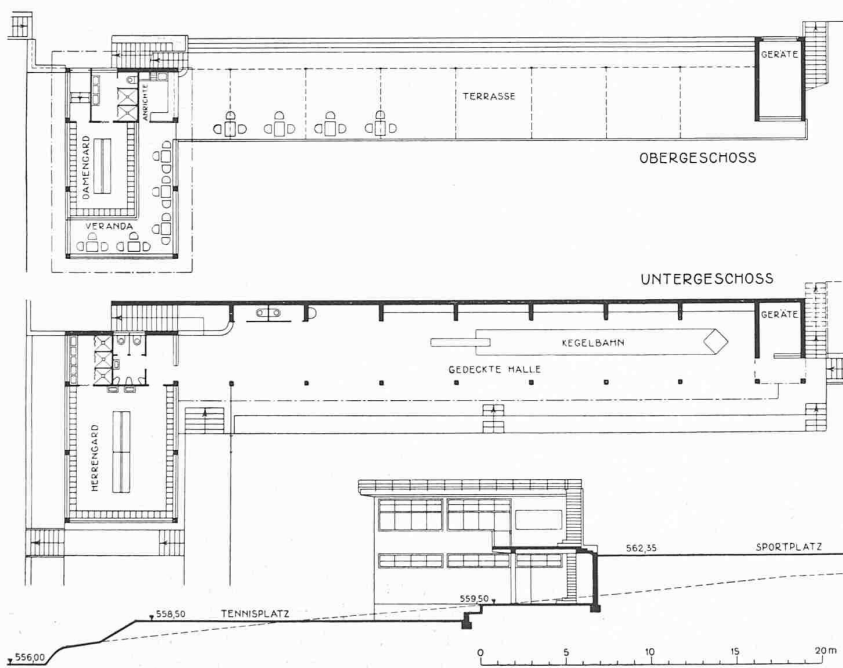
und 8. Grundrisse und Schnitt des Terrassen-Gebäudes. — Masstab 1 : 400.
